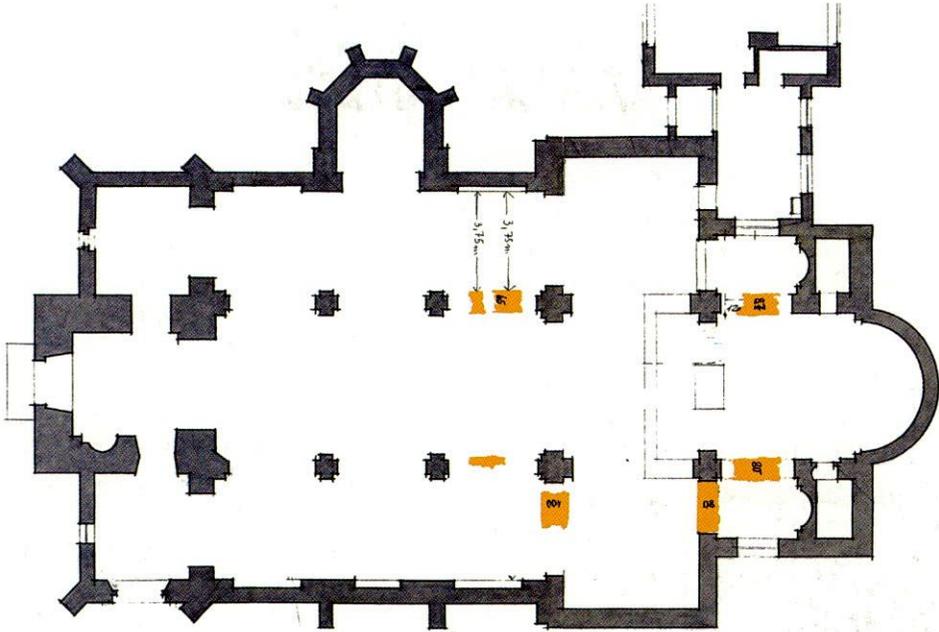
Bergheim, St. Remigius. Grundriss von 1970/71 mit Eintragung der beim Heizungseinbau aufgedeckten Abschnitte der stauferzeitlichen Spannfundamente im Chor und Langhaus (ockerfarben); ohne Maßstab.
